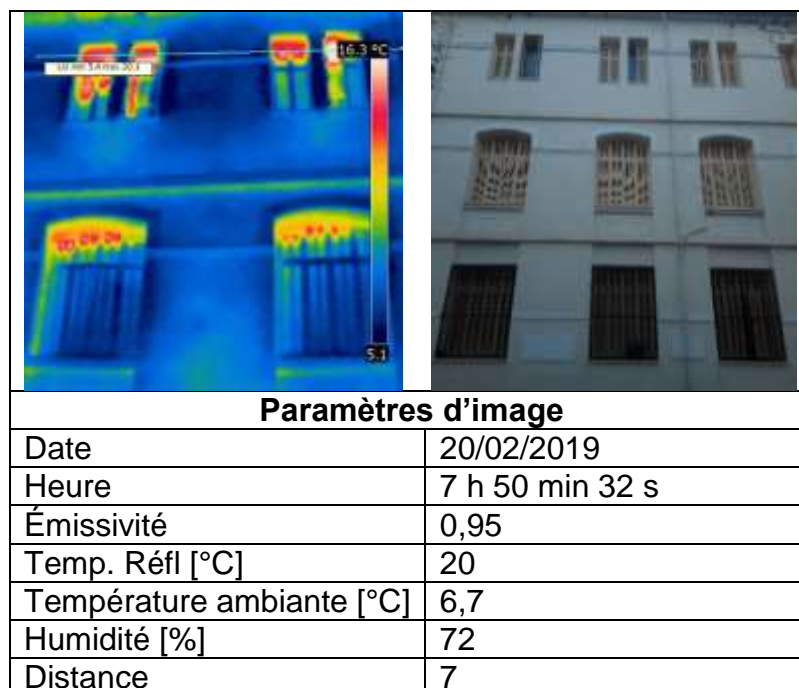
Ponts thermiques horizontaux en haut des fenêtres (façade ouest du lycée Ferroukhi).
